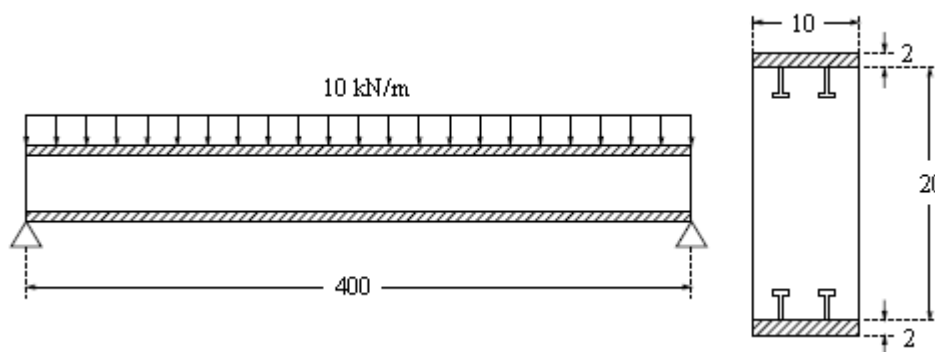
Viga mista bi-apoiada (cotas em cm)
